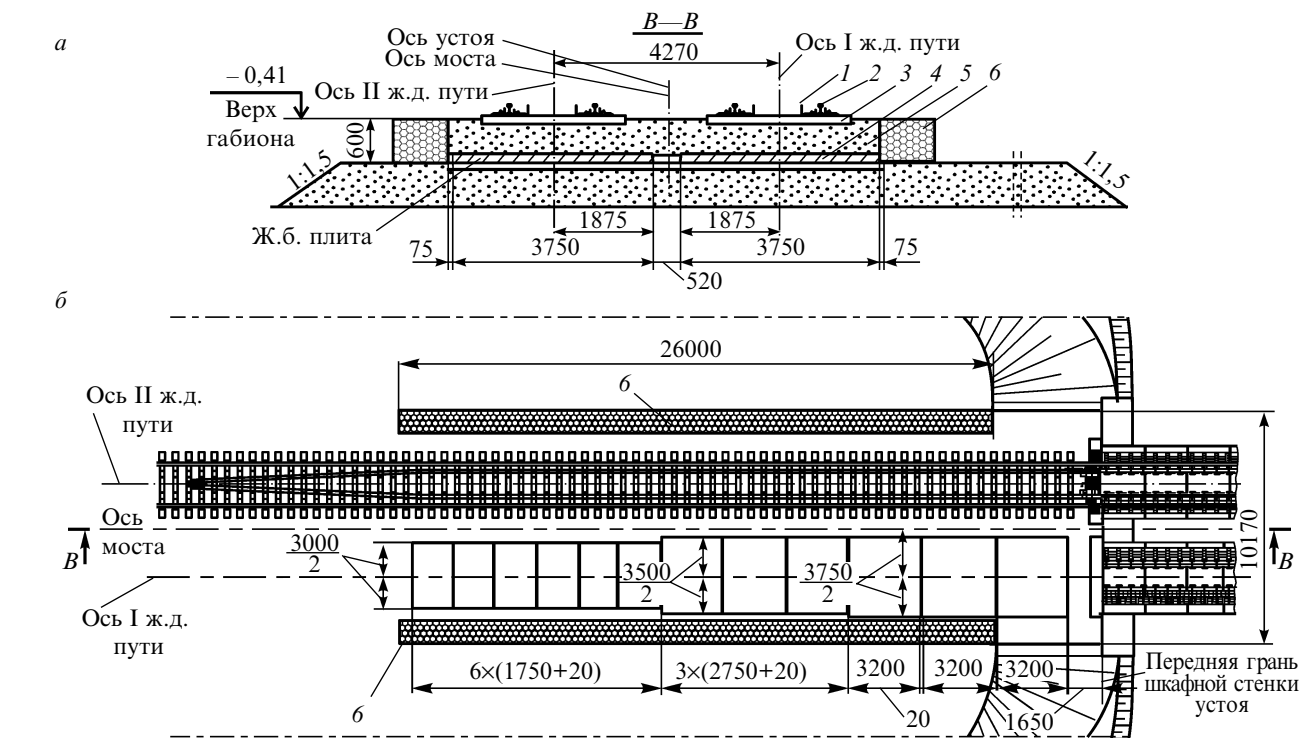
Конструкция переходного пути с подбалластным покрытием железобетонными плитами на подходах к мосту (размеры в мм):
